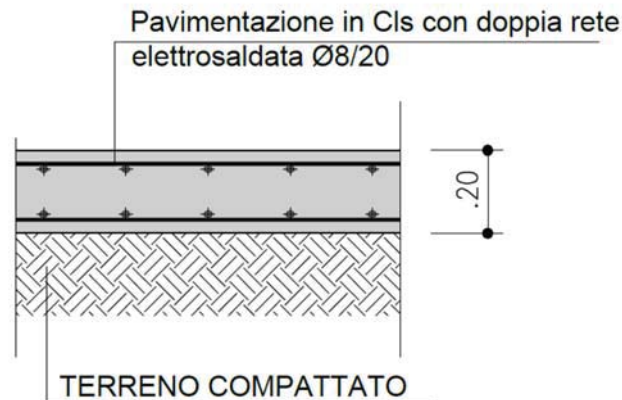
Stralcio del dettaglio tipologico della pavimentazione esistente sull'area.
